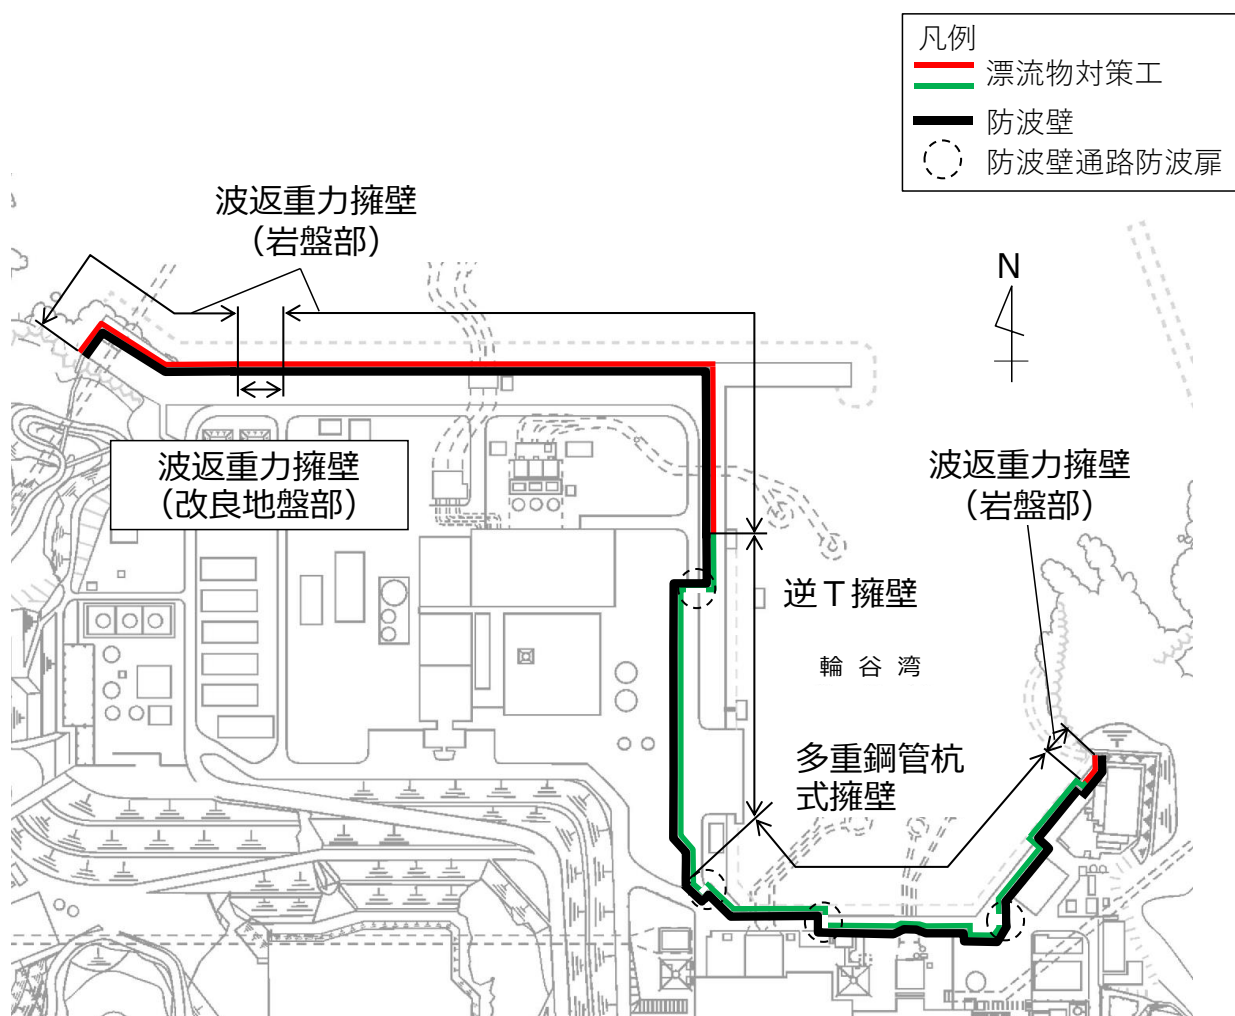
漂流物対策工（鉄筋コンクリート版）の位置図
